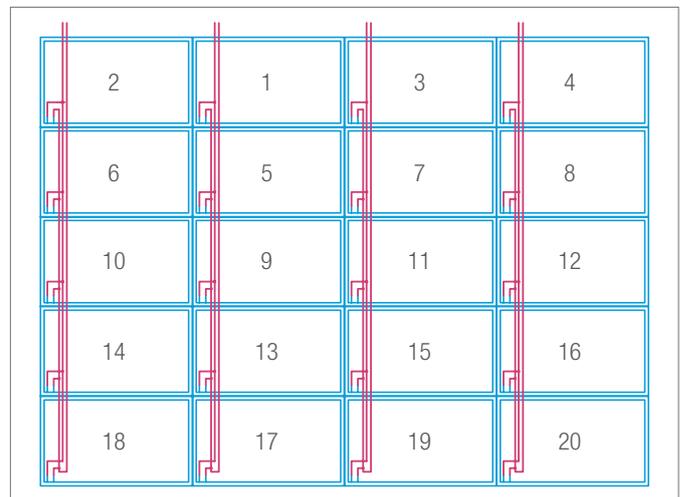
Schematische Darstellung der Installationsreihenfolge der Deckenelemente großer Deckenflächen
